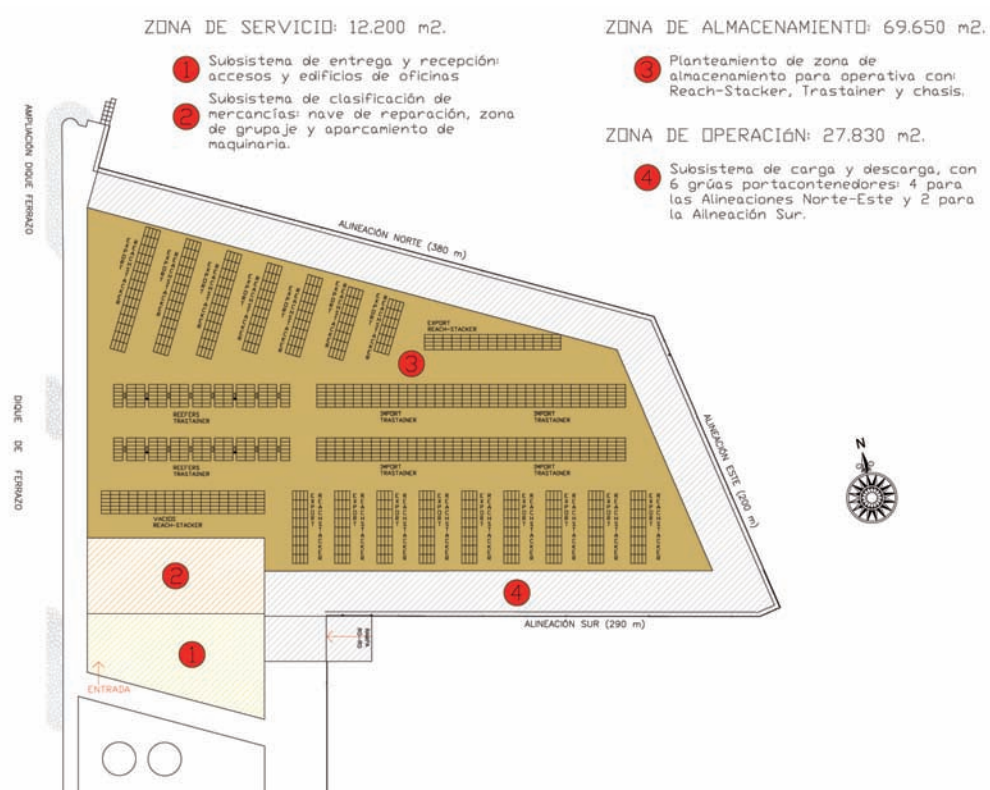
Planteamiento del futuro de la Terminal de Contenedores.
